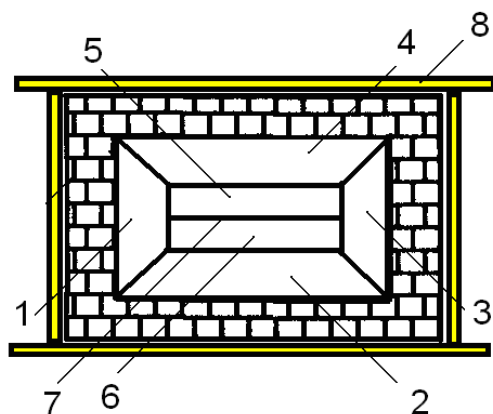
Схема предохранительной разрушающейся конструкции ограждения зданий.
